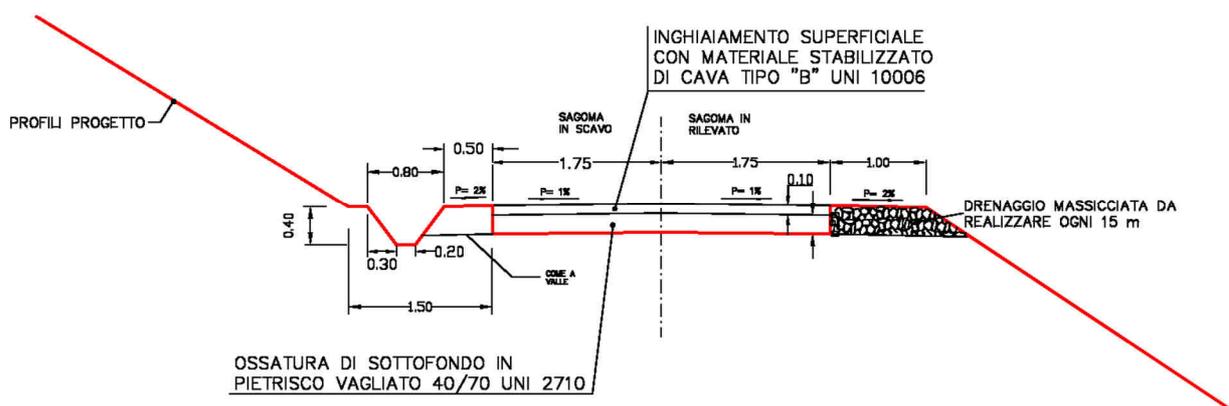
Schema tipologico sezione viabilità
